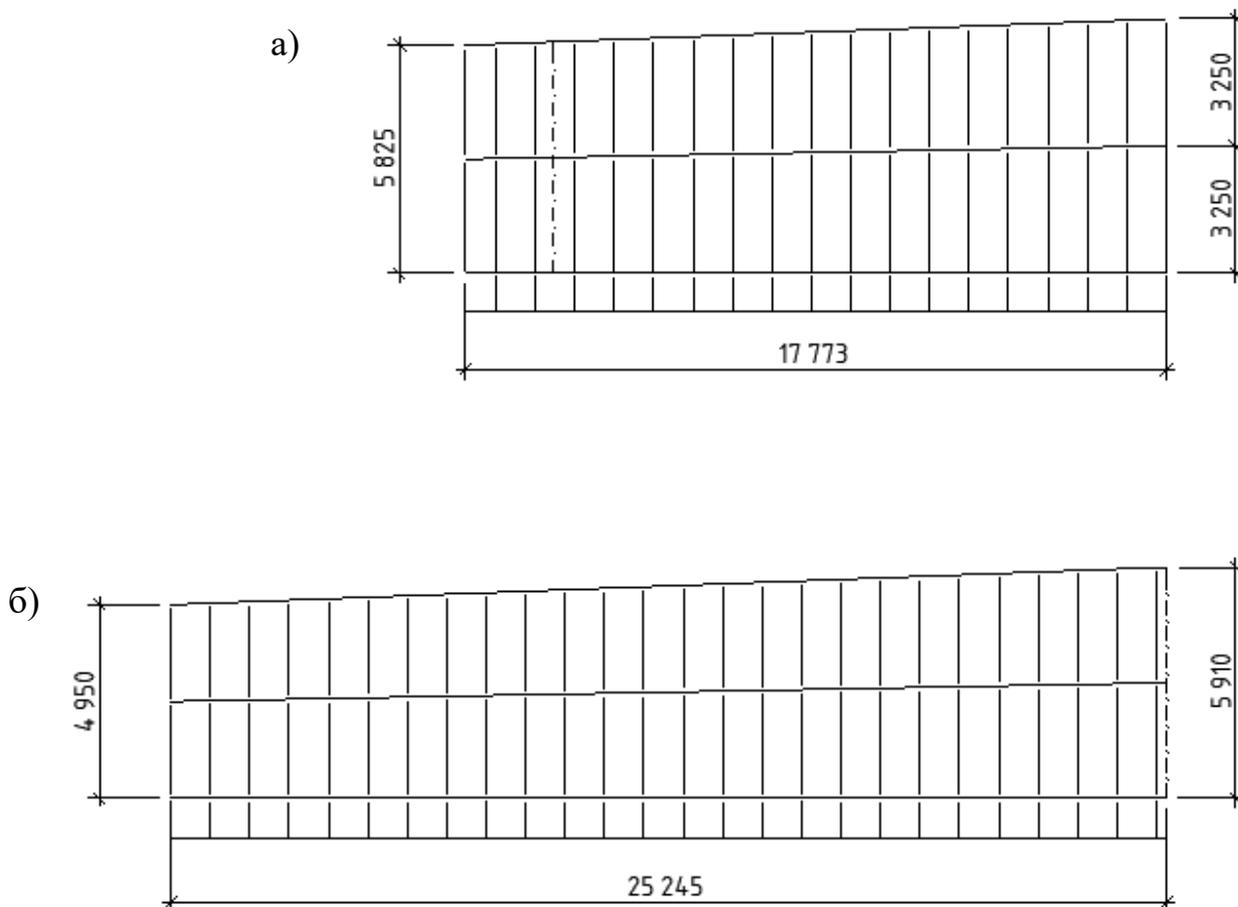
План покрытия по аркам (а - полуарка 2, б – полуарка 1) автовокзала
